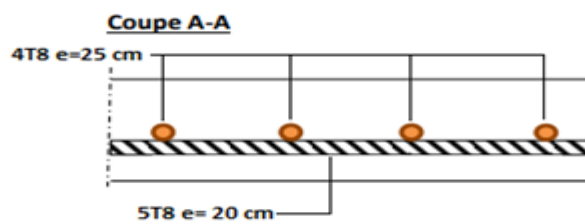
Schéma de ferrailage du plancher de l'étage courant et de la terrasse
